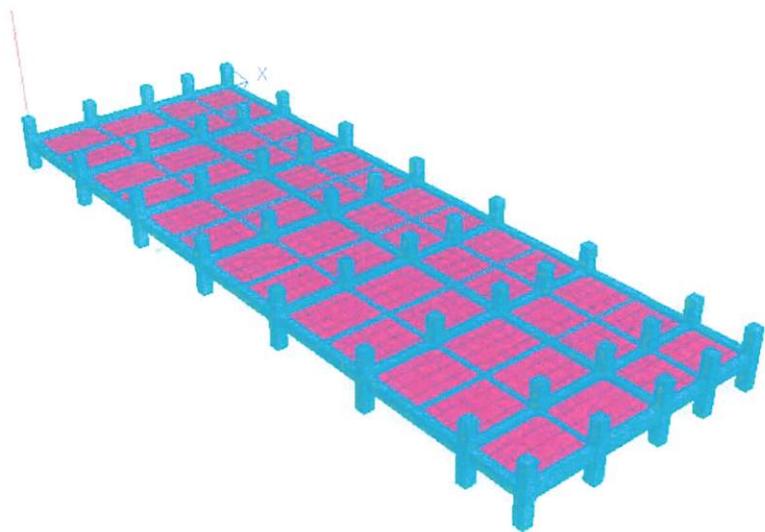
Pemodelan struktur Lantai 6 pada STAAD Pro
